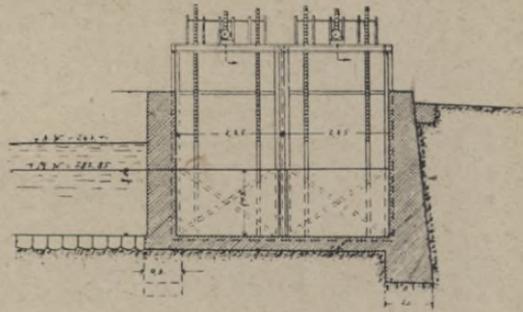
Einbau einer Grundschleuse in ein festes Mühlenwehr.
